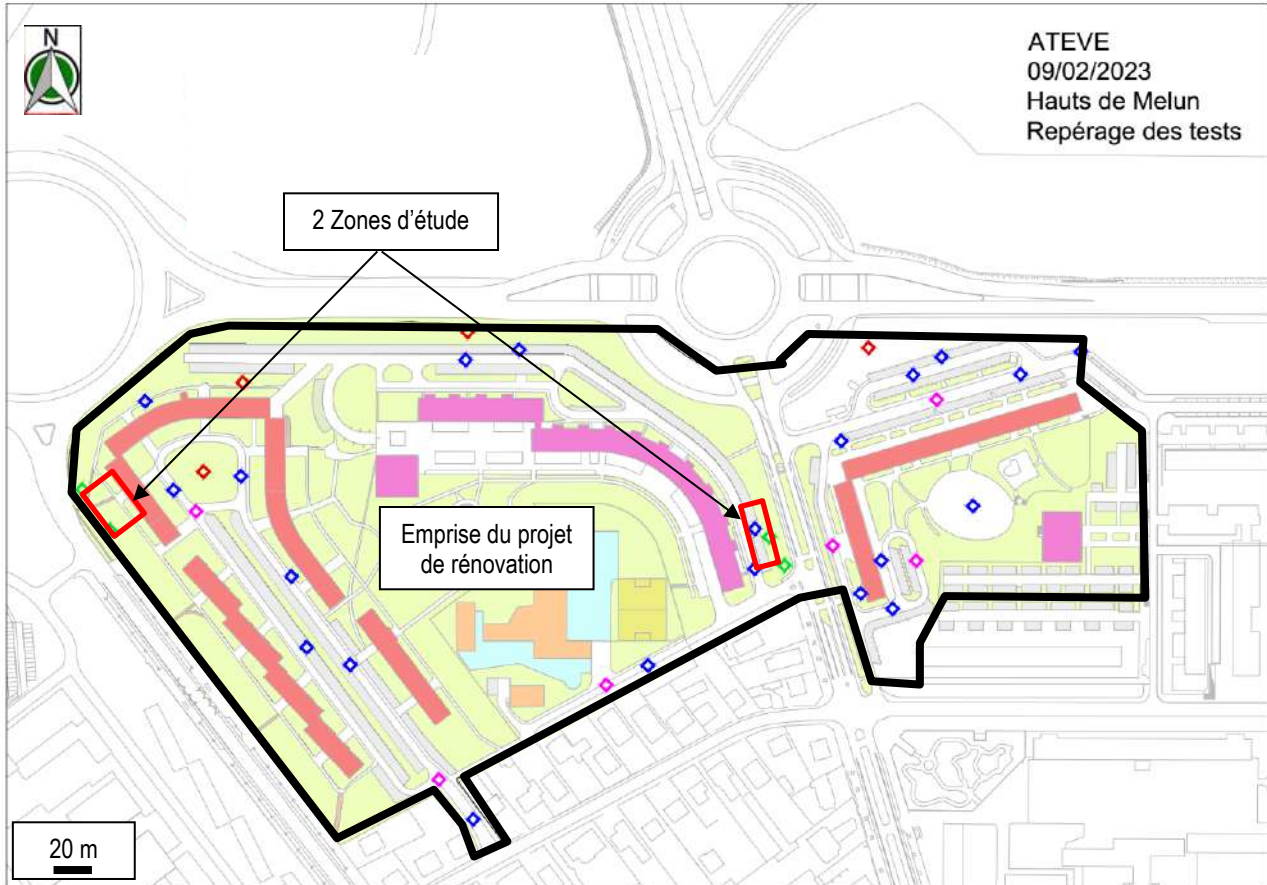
Plan du site actuel (Source : Donneur d'Ordre)
